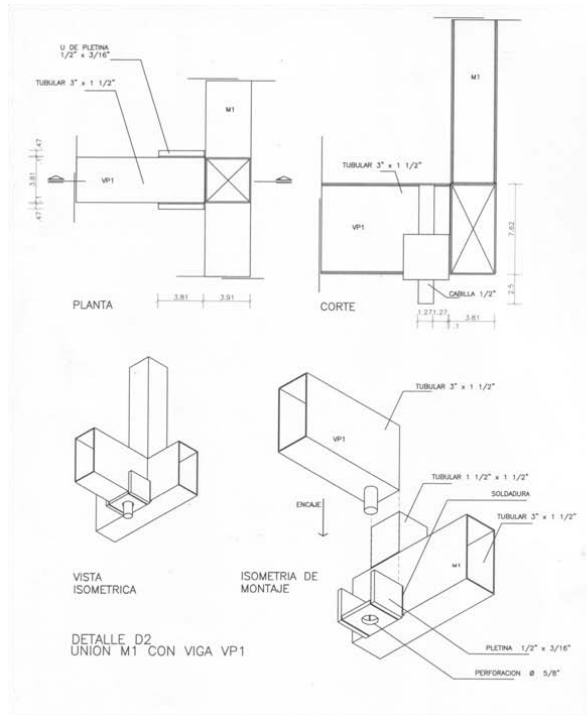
Detalle unión Viga VP1 y Marco M1. F: Ana Marrero
